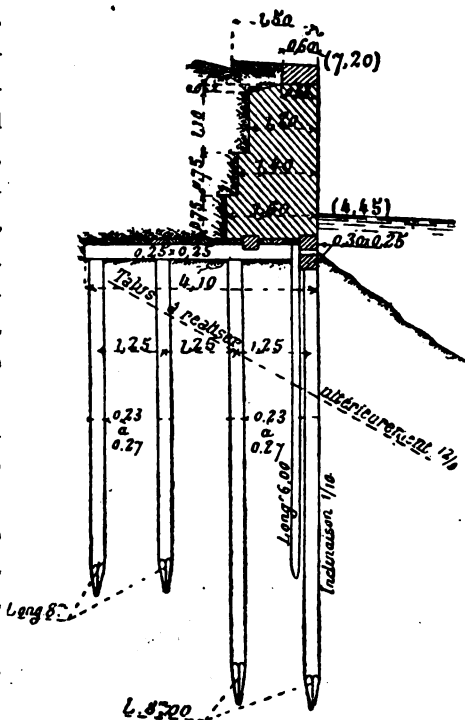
Sezione trasversale del muro progettato su piattaforma di legno.
